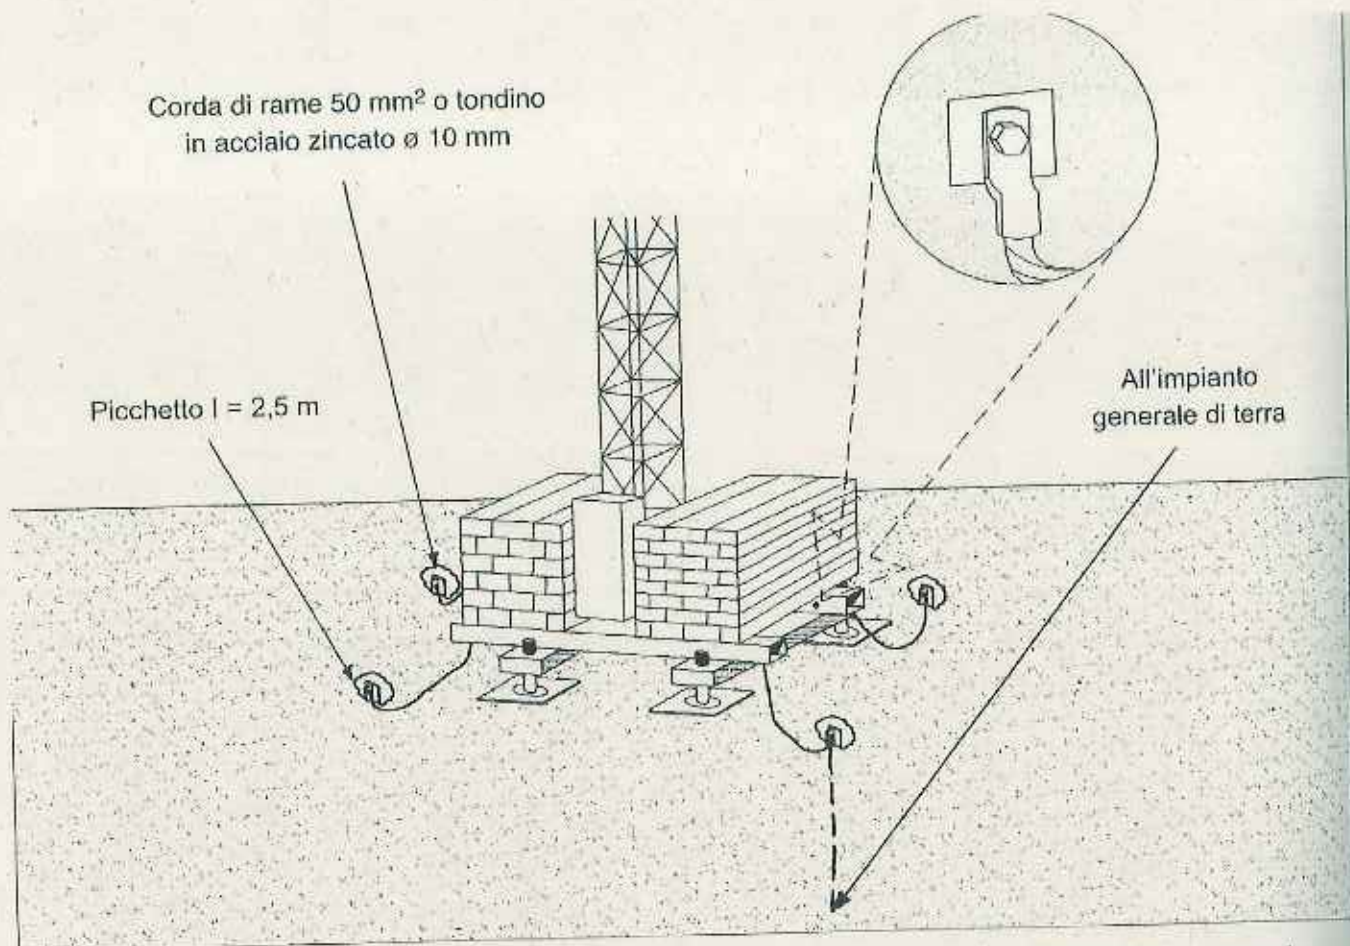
Esempio di collegamento a terra di una gru ai fini della protezione contro le sca-
